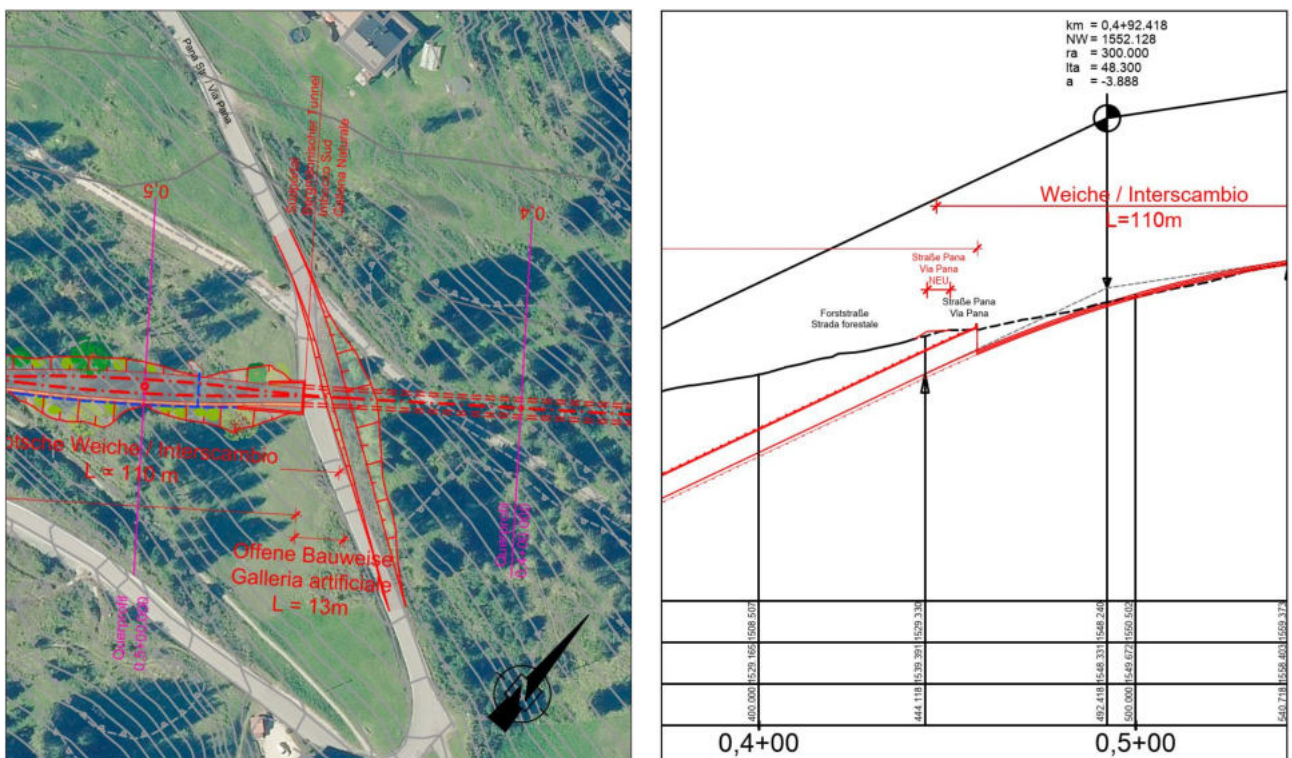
Auszug Lageplan und Längenschnitt Unterquerung Pana Straße Bereich Südportal
